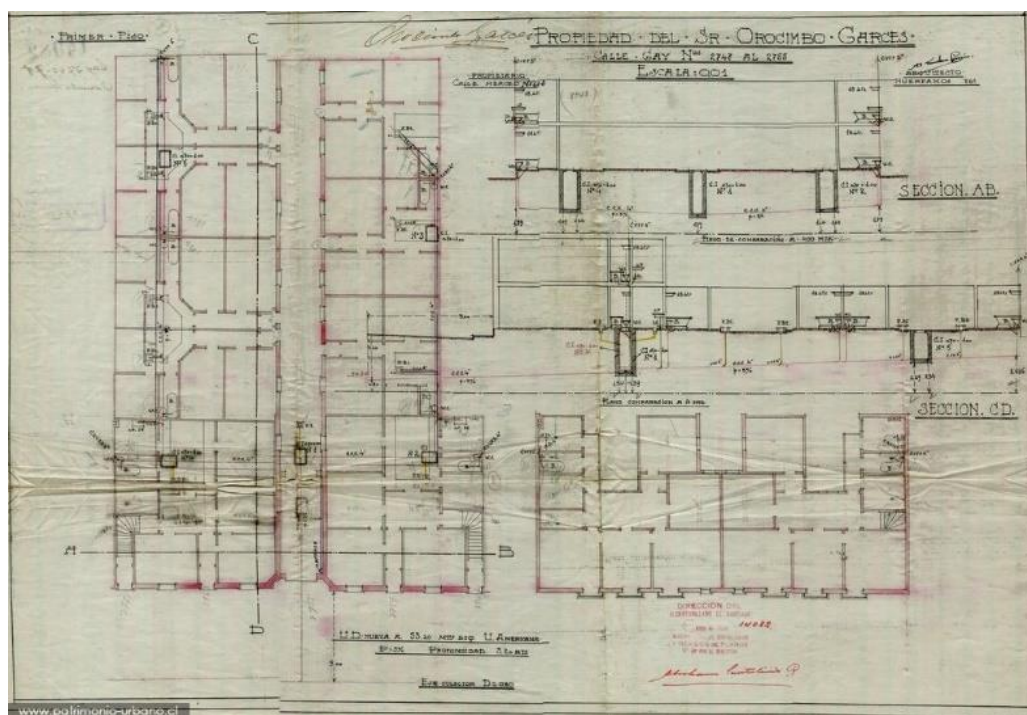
Plano cité Santa Teresa, Santiago. Fuente: Patrimonio Urbano
